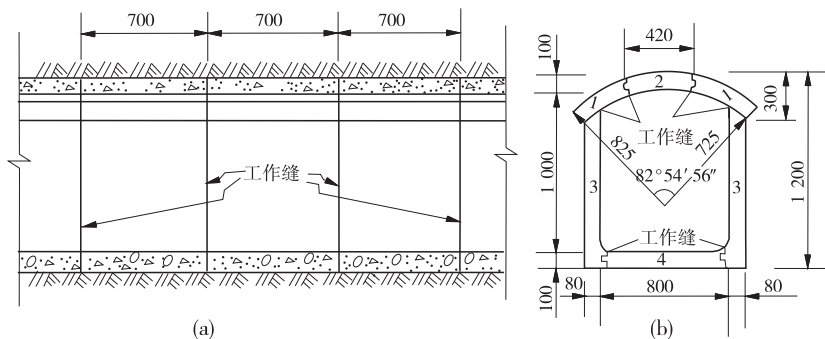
陆浑水库泄洪洞衬砌施工缝 (单位:cm)
